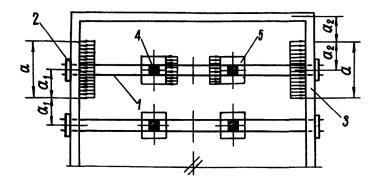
У.1. Раочетная схема стальных затяжек связи-распорки, устраиваемой в пределах цоколя или фундамента:
